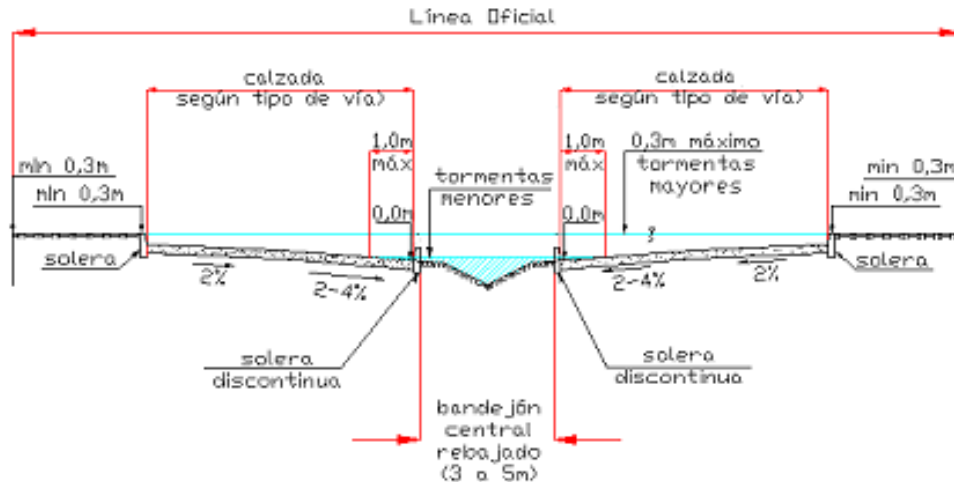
Ejemplo de sección transversal alternativa en Vías Colectoras y Troncales con cuneta al centro de la calzada y un bandejón central para conducir las aguas lluvias en zanja abierta.
